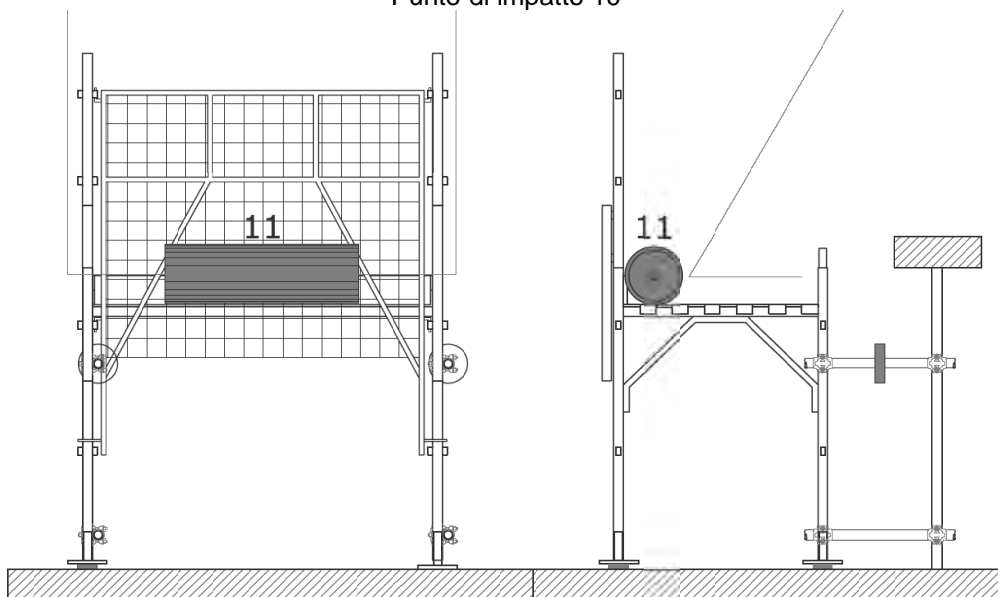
2 Prove d'impatto con rullo cilindrico su protezione continua – Schema CSR – Punto di impatto 11
